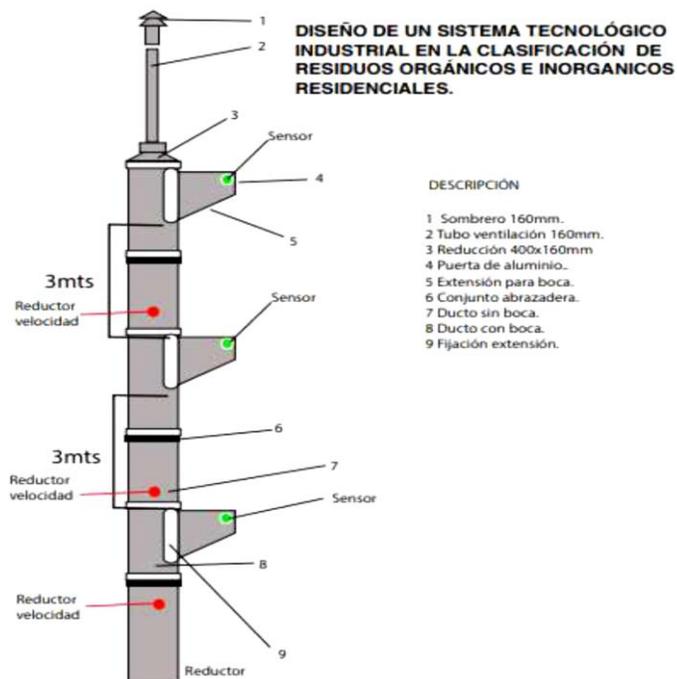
Partes del shute de basura con sus partes y componente. Realizado por Karen Bedoya el 4 de mayo de 2019.
